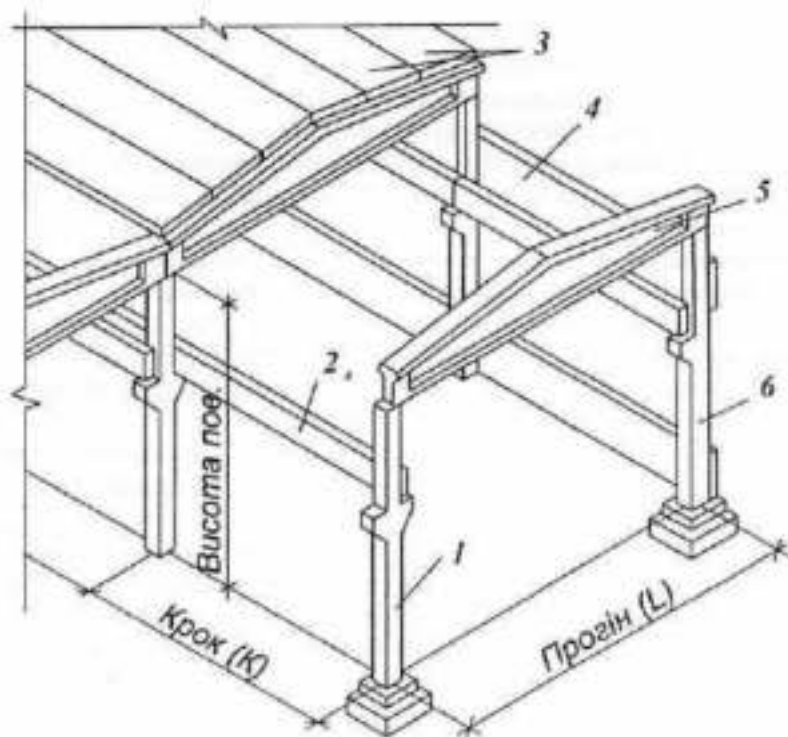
Об'ємно-планувальний елемент будівлі каркасної конструктивної системи: 1 – середня колона; 2 – підкранова балка; 3 – плита покриття; 4 – стінова панель; 5 – крок'яна балка; 6 – крайня колона
